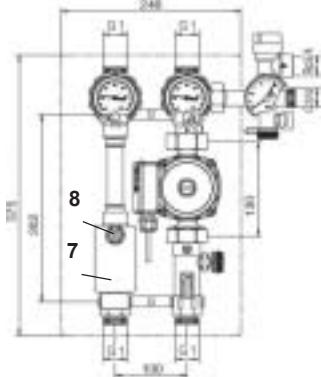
Posizione d'installazione del gruppo di collegamento pompe
